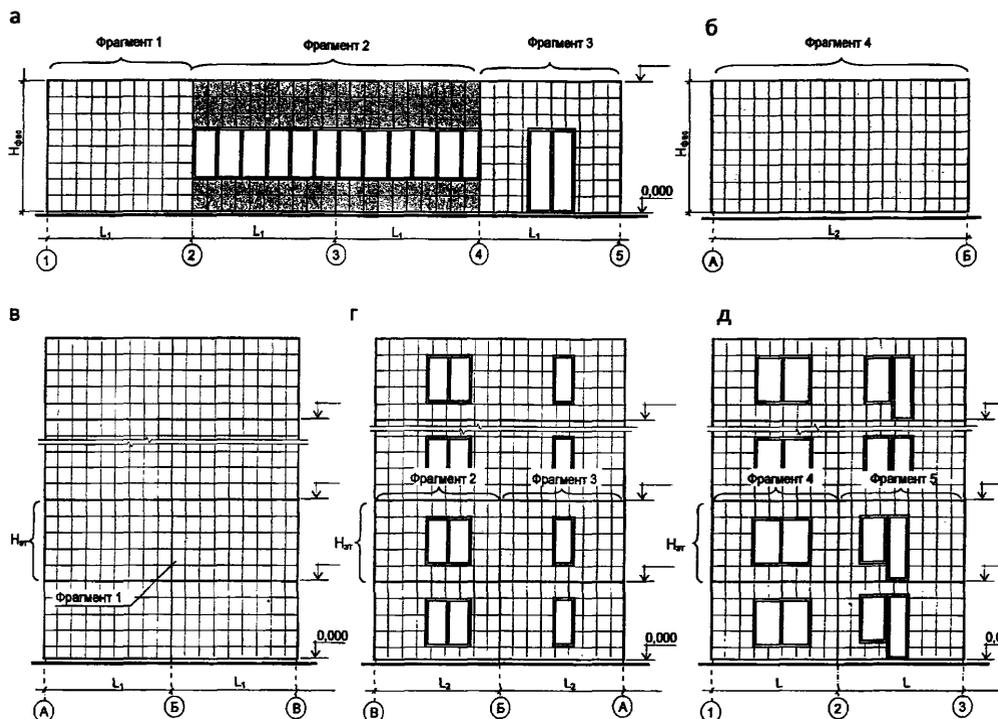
Примеры разбиения фасада здания (а, б) или промежуточного этажа (в, г, д) на отдельные фрагменты для расчета приведенного сопротивления теплопередаче
